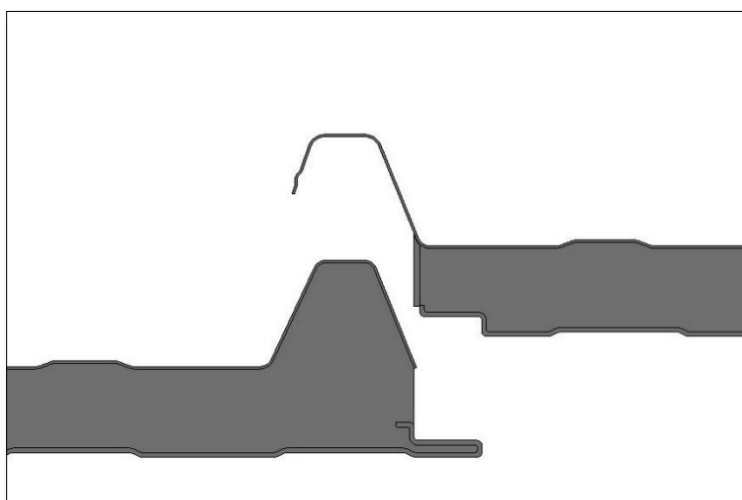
Sobreposición entre paneles tipo sándwich del proyecto
